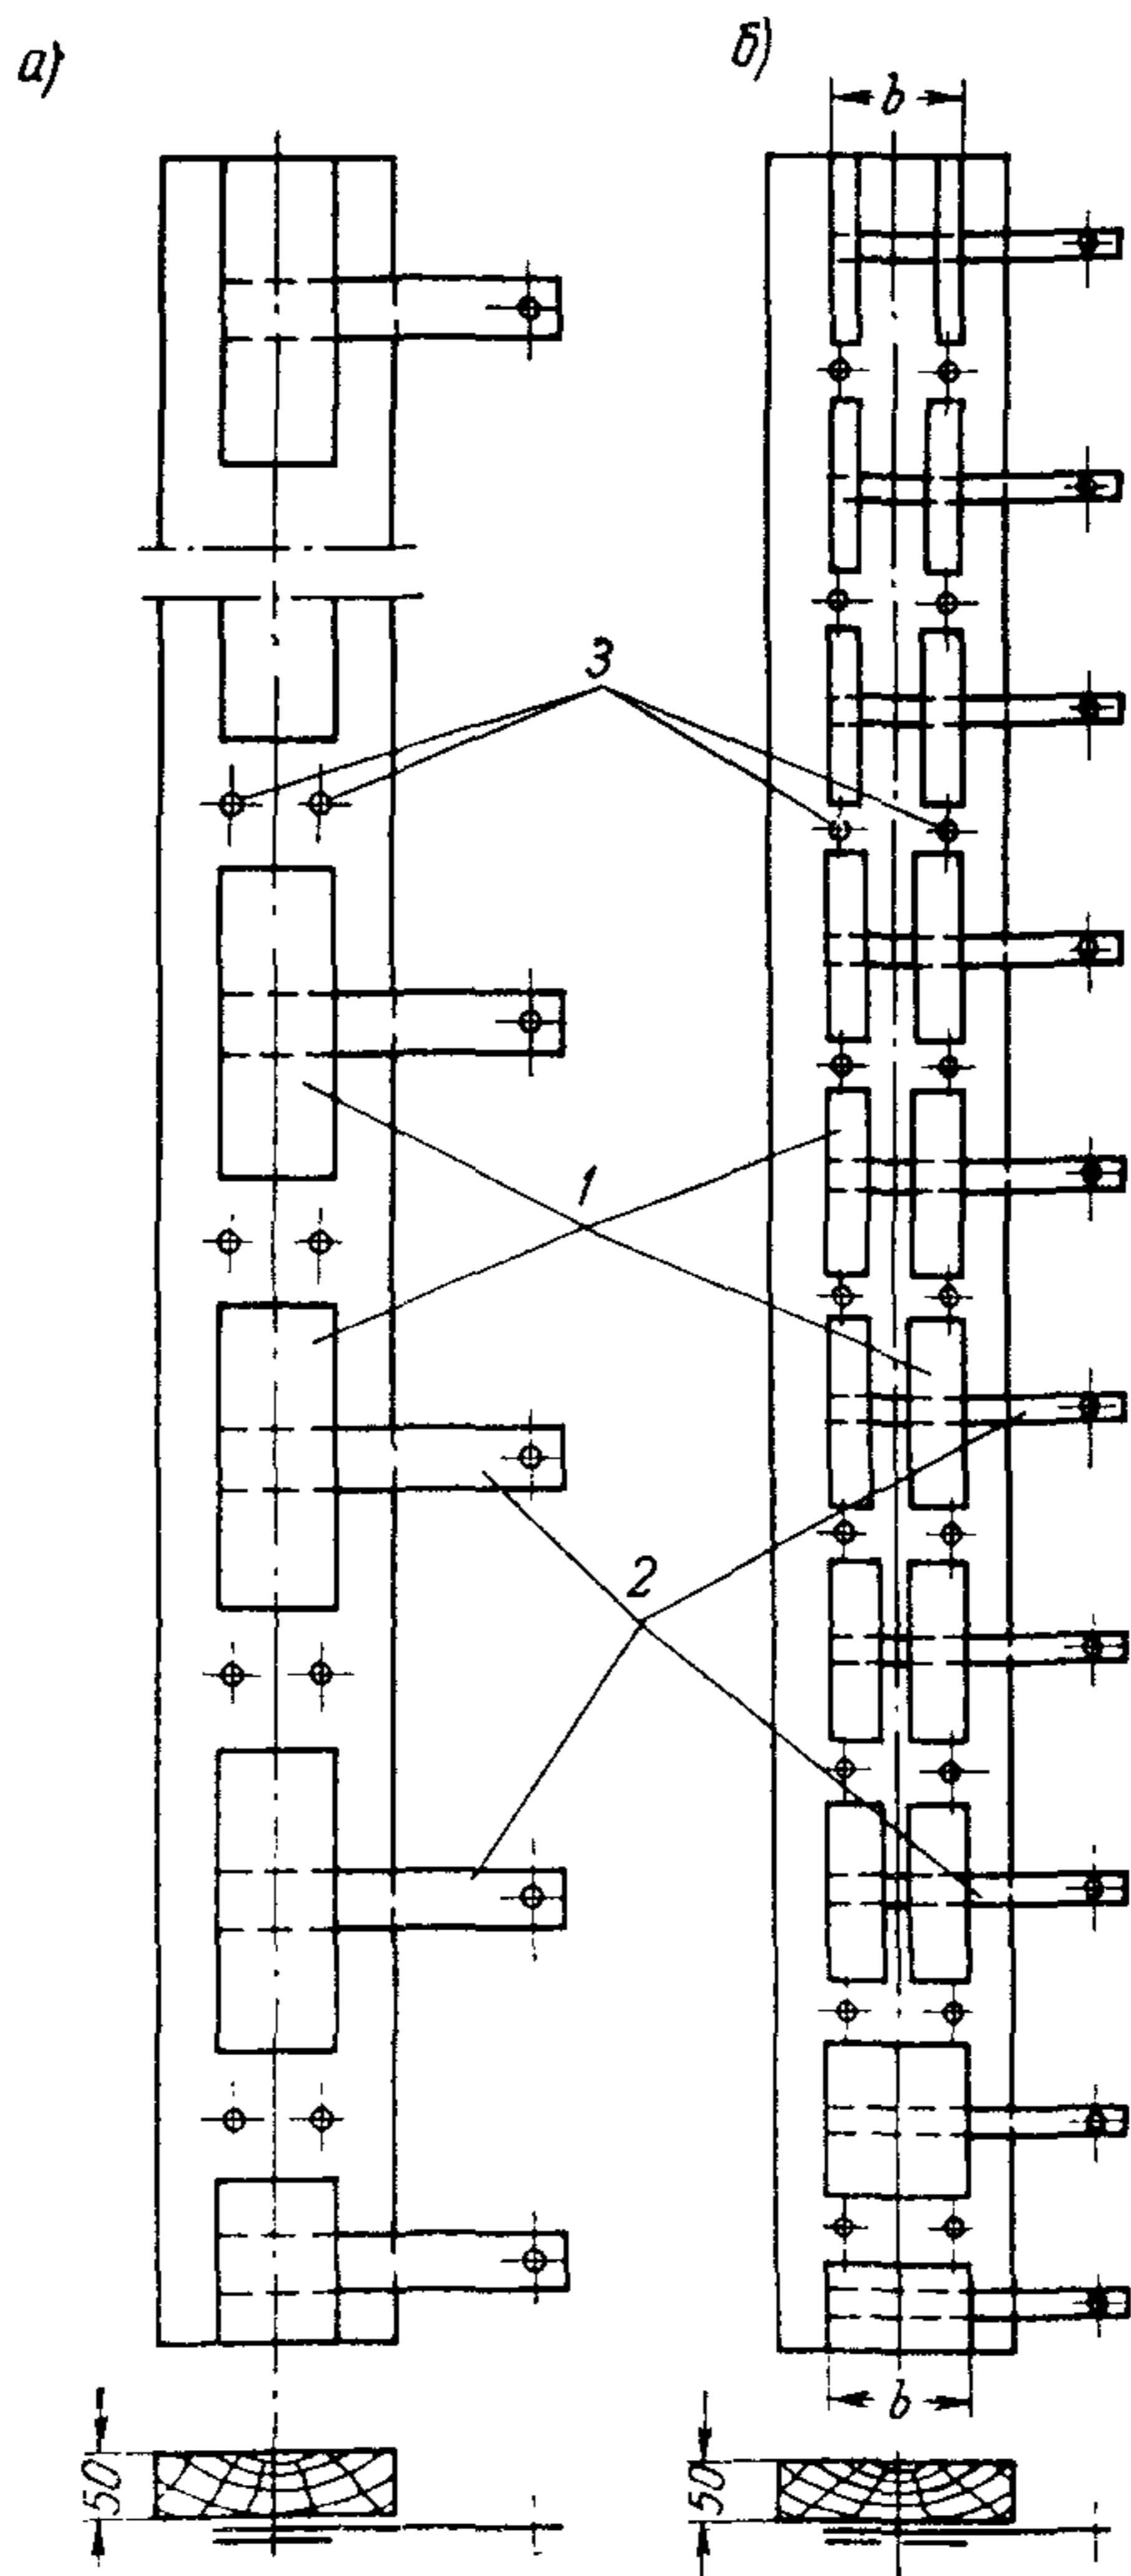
Примерные схемы размещения пластинчатых электродов на опалубке для электропрогрева бетона стыков между стеновыми панелями
